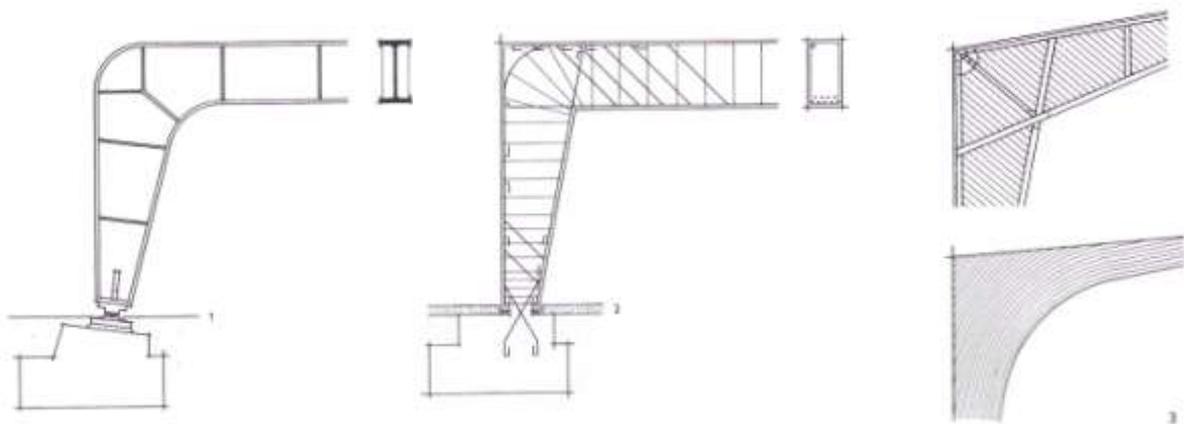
A união rígida dos membros, trave e apoios. 1) pórtico em aço; 2) pórtico em concreto; 3) pórtico em madeira, as uniões precisam de reforço em aço ou prensas, como n madeira laminada. Fonte: (SIEGEL, 1966).
